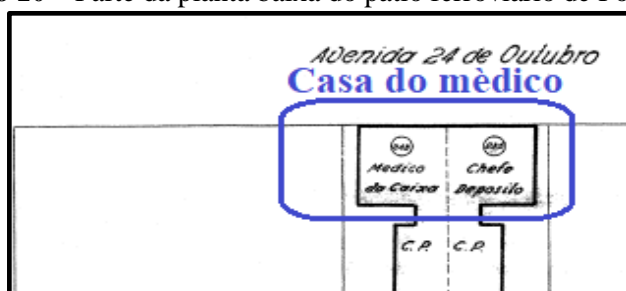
Parte da planta baixa do pátio ferroviário de Porto Ferreira
